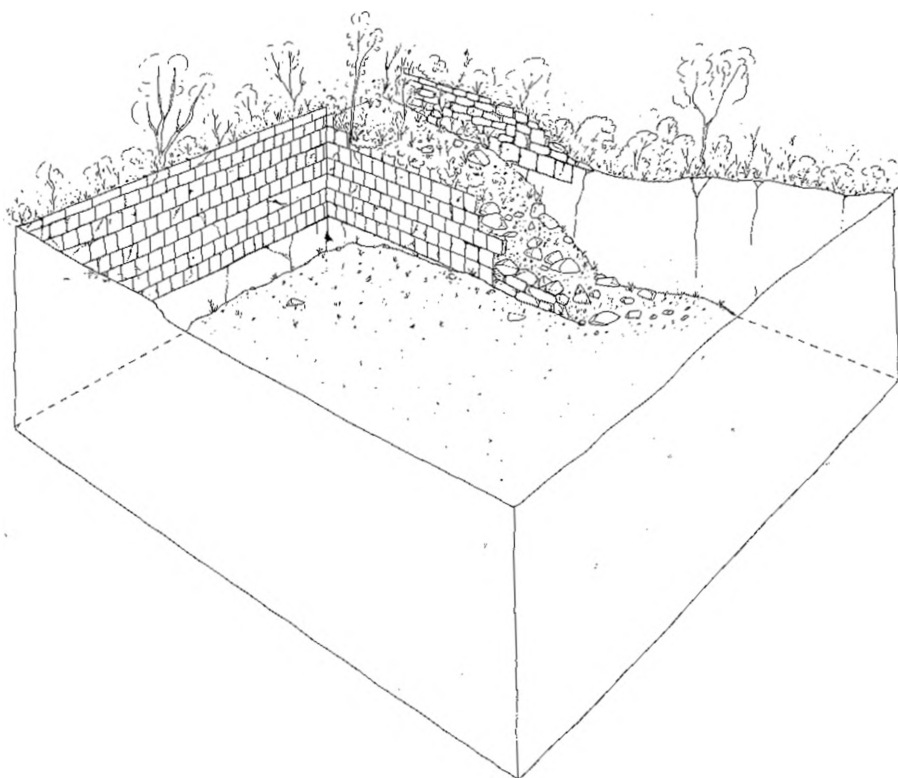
Vignale: cisterna meridionale. Schizzo prospettico dell'ambiente visto dall'angolo meridionale.
